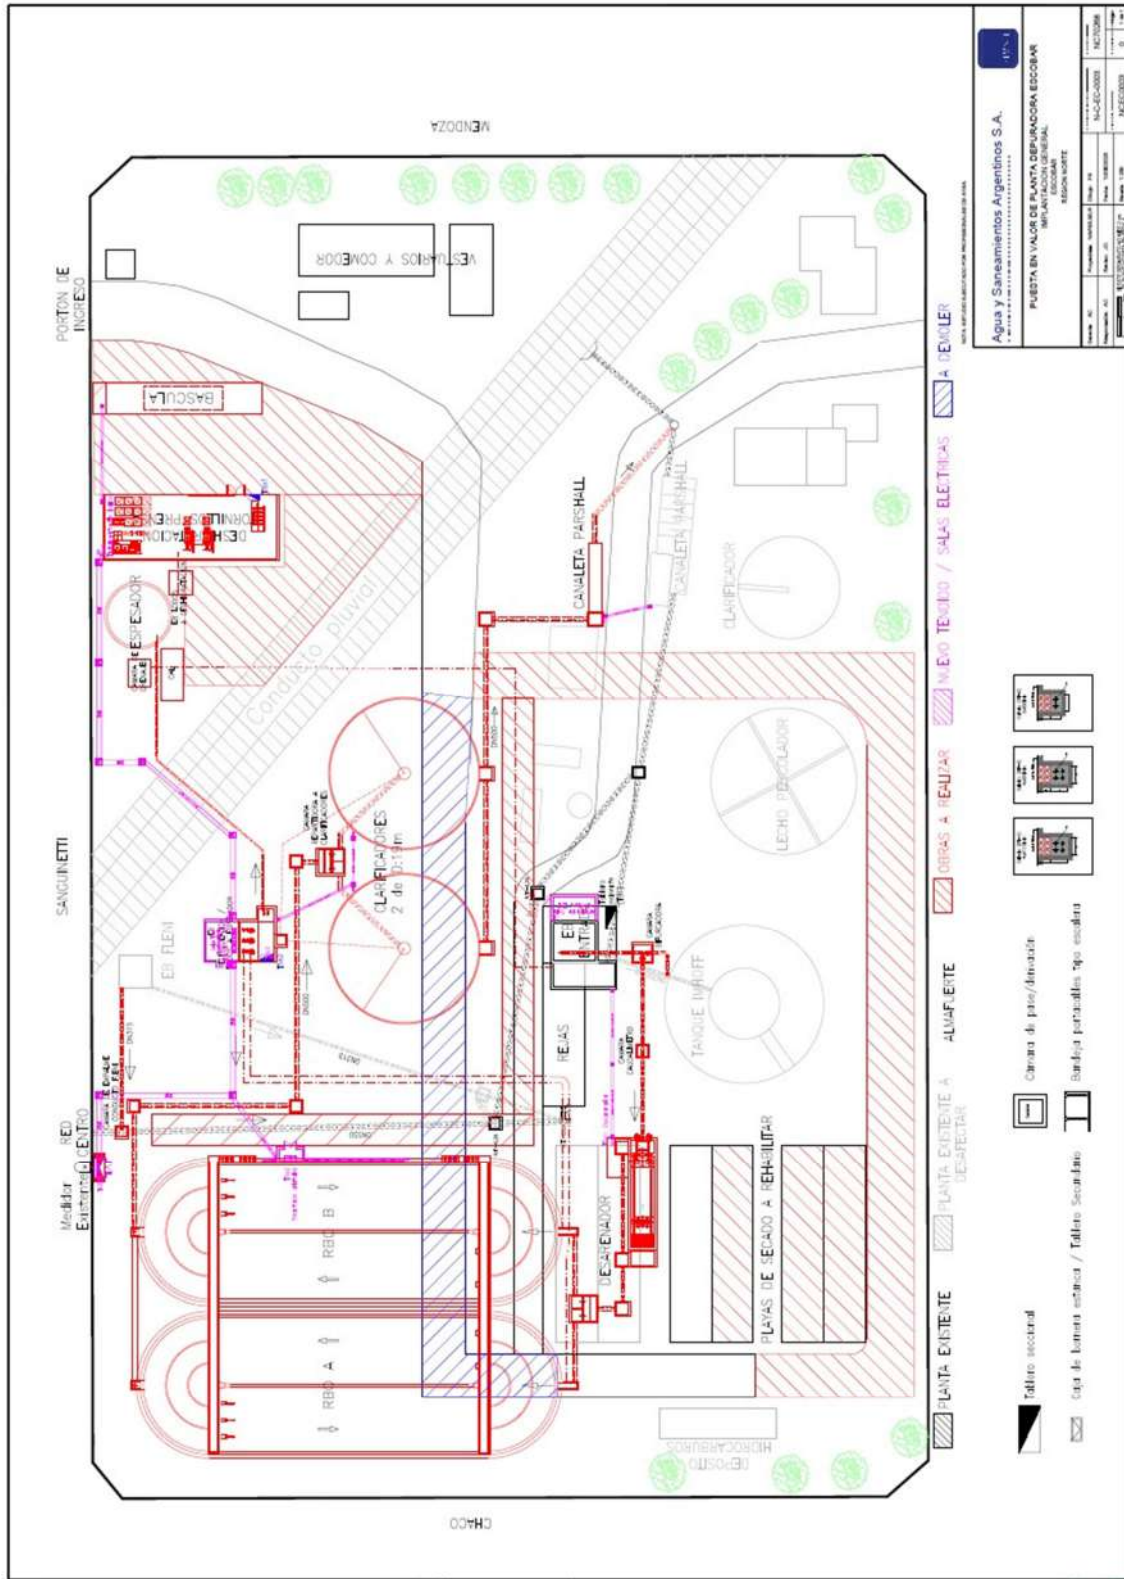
Proyecto puesta en valor Planta Depuradora Escobar.
